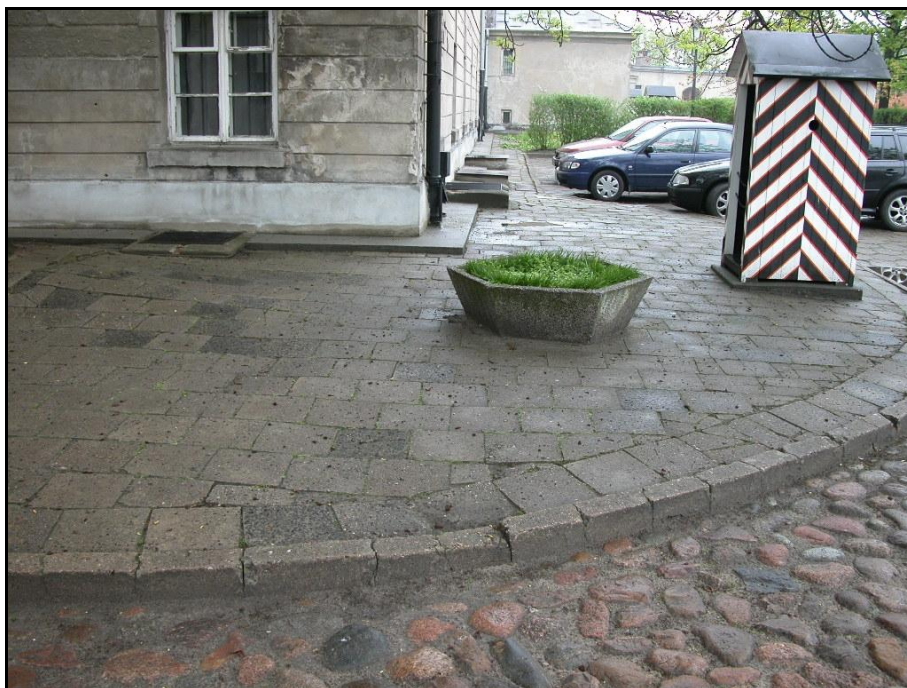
Nawierzchnia chodnika z płyt betonowych o wym. 35 x 35 cm, zapadnięte płyty. Donica betonowa.
